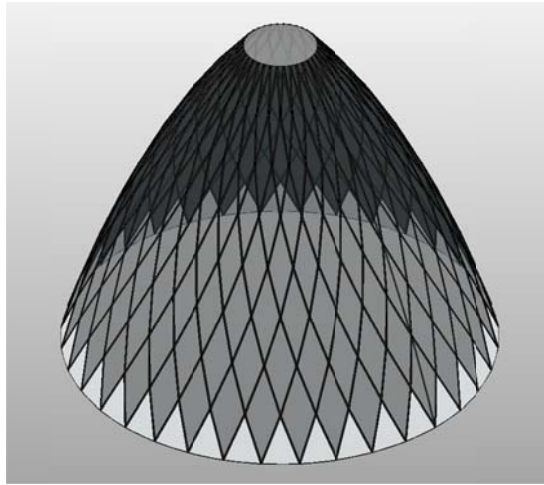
Detalle de división de la cúpula y paneles. Elaboración propia con software BIM.
